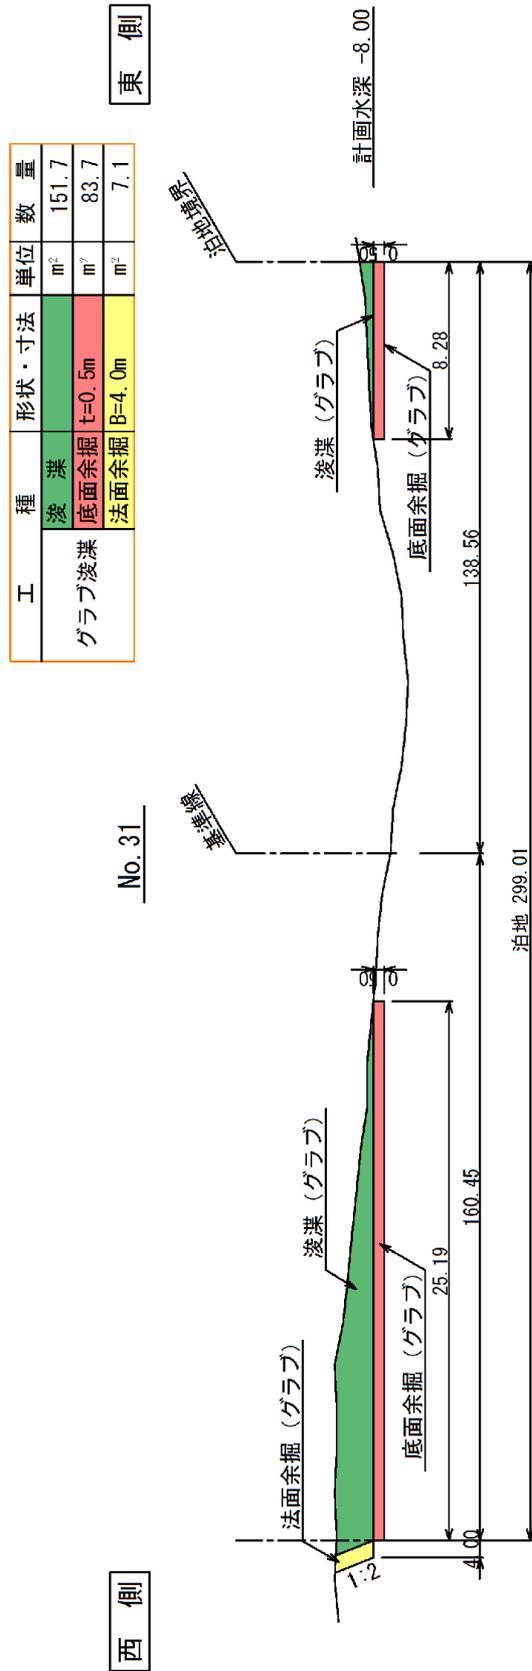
No.2 大洗港区_中央地区泊地 (-8m) の断面図 (復旧後)
